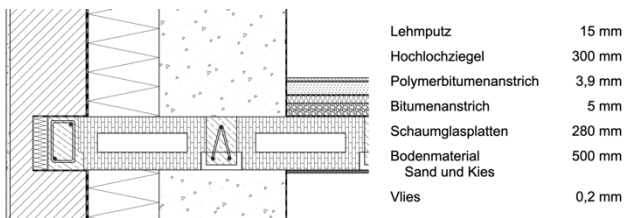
Detail Auflager Ziegel-Einhängedecke (maßstablos)
